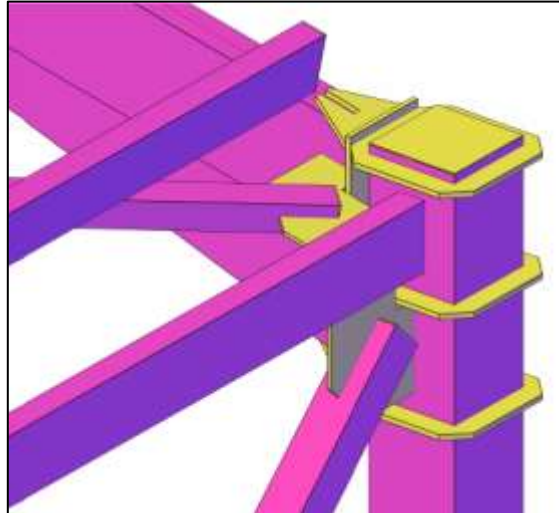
Conexión a corte Tranque – Columna (Perfiles: tubulares)
